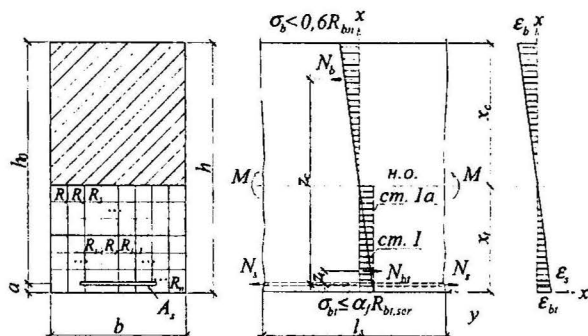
Расчетная схема нормального сечения изгибаемого железобетонного элемента до образования трещины (стадии I, Ia НДС)
